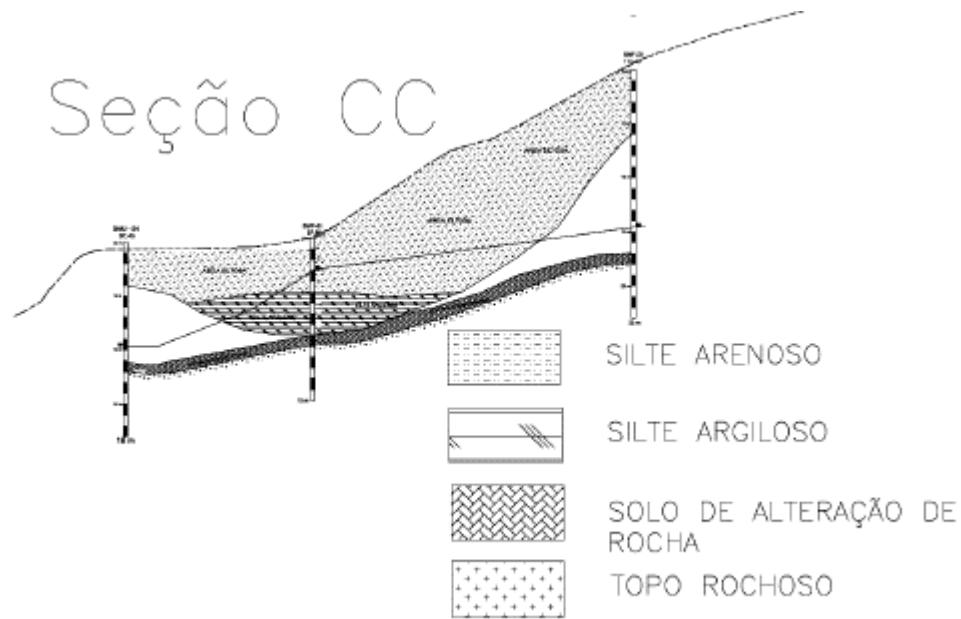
Perfil Geotécnico definido pelas Sondagens Mistas – Seção “CC”
